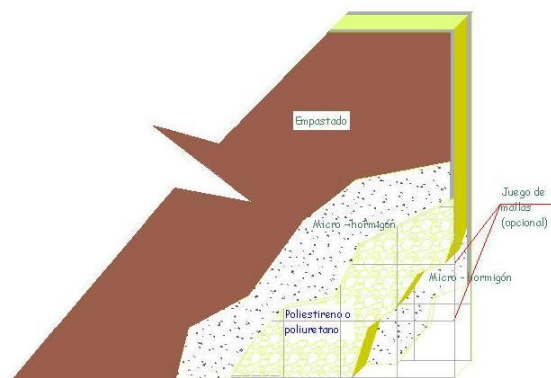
Detalle constructivo de un panel prefabricado de HORMYPOL;
